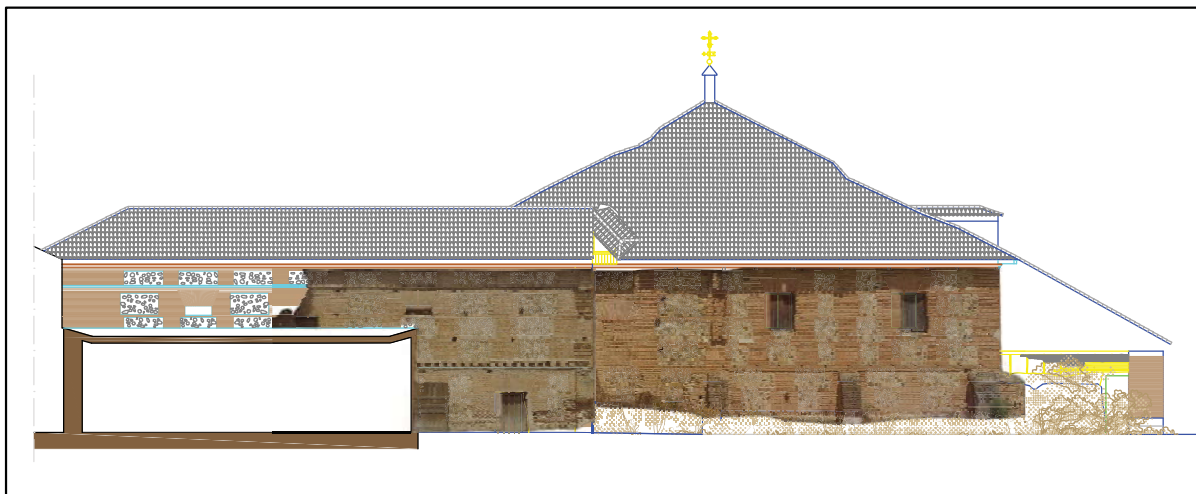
Alzado de las fachadas de la zona norte sobre el levantamiento realizado por el equipo redactor del proyecto de restauración. A la izquierda de la imagen existe un vacío en la imagen originado por la elevada vegetación existente en el claustro.
